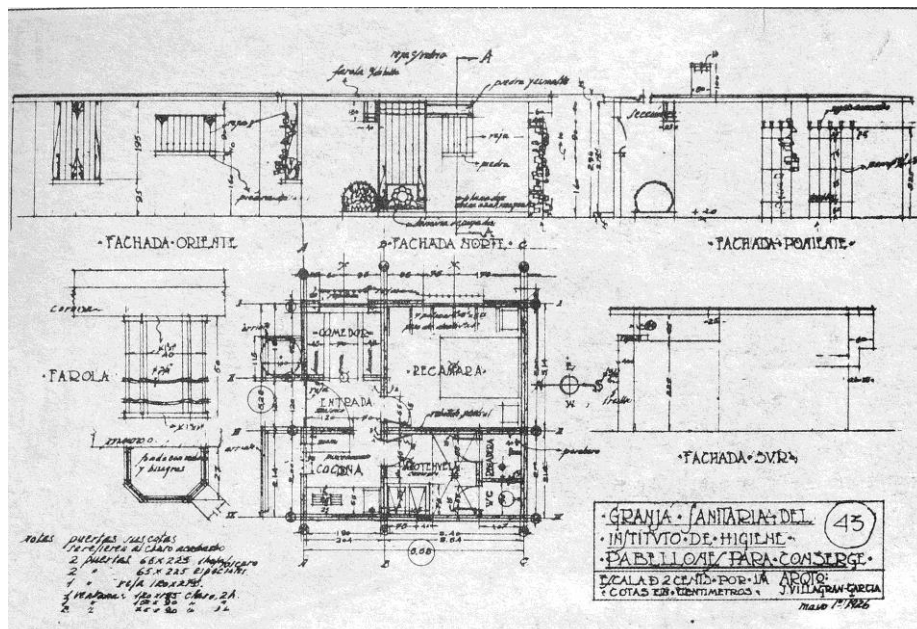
保健医療センター(設計ビジャグラン) 平面図, 立面図
